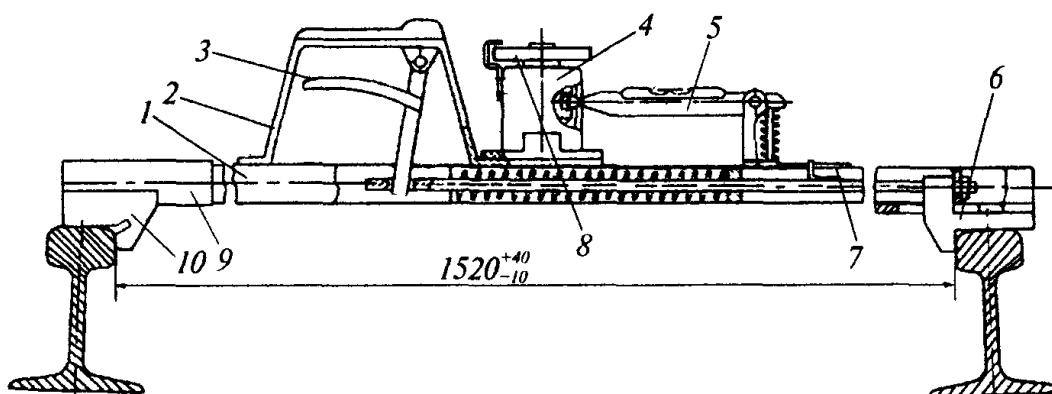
Загальний вигляд колійного контрольного шаблону ЦУП-2Д:
